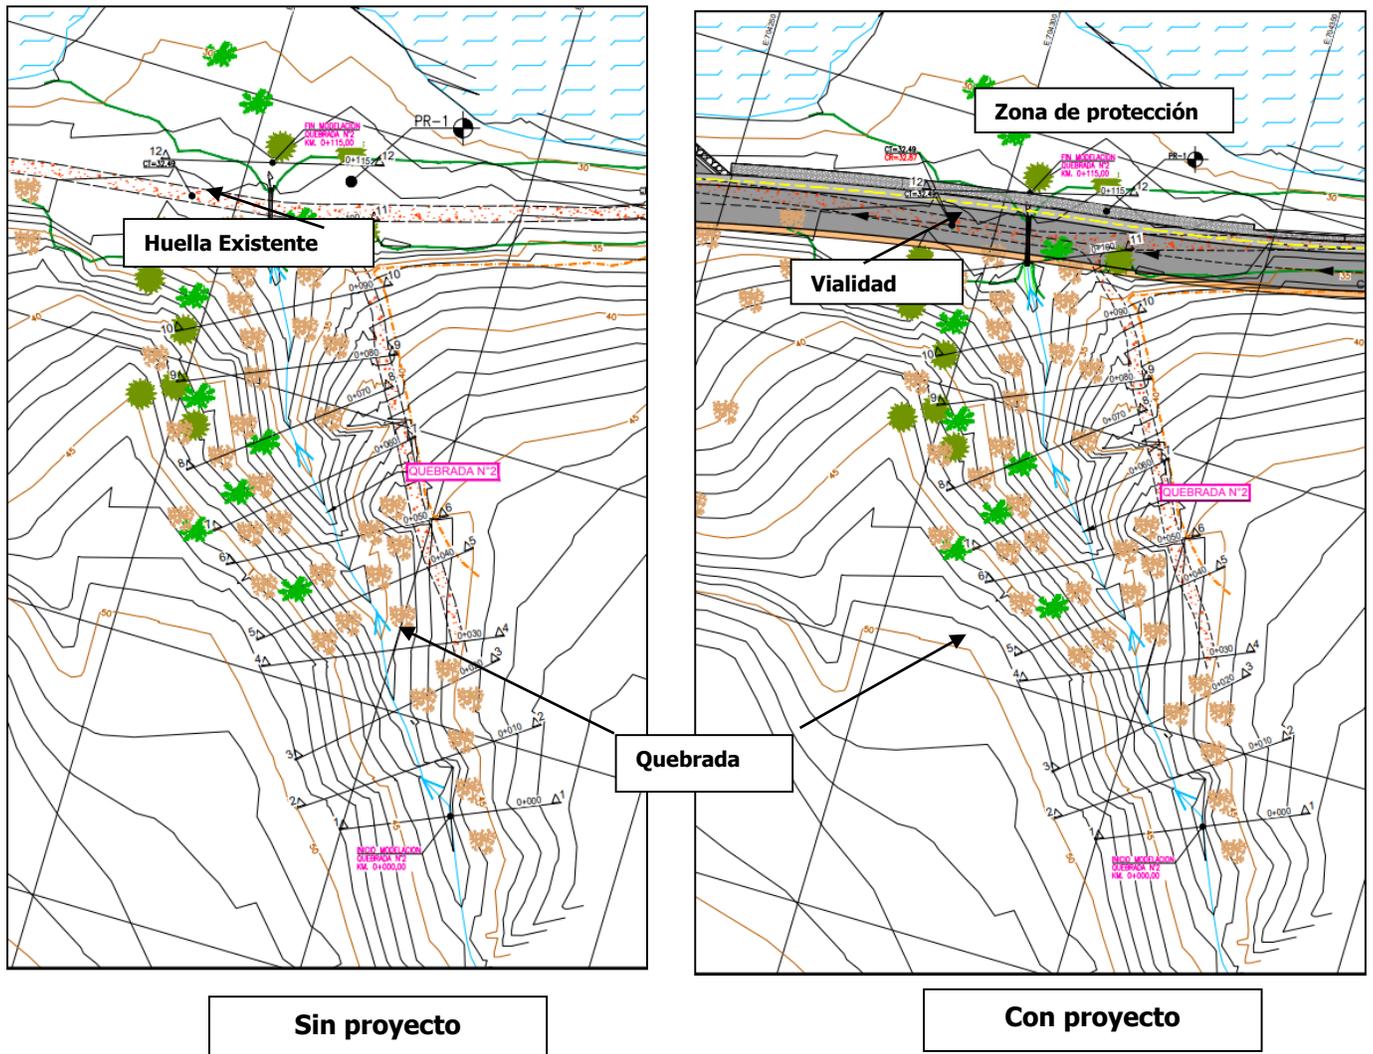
Detalle Quebrada 2 con y sin proyecto ZPdr
